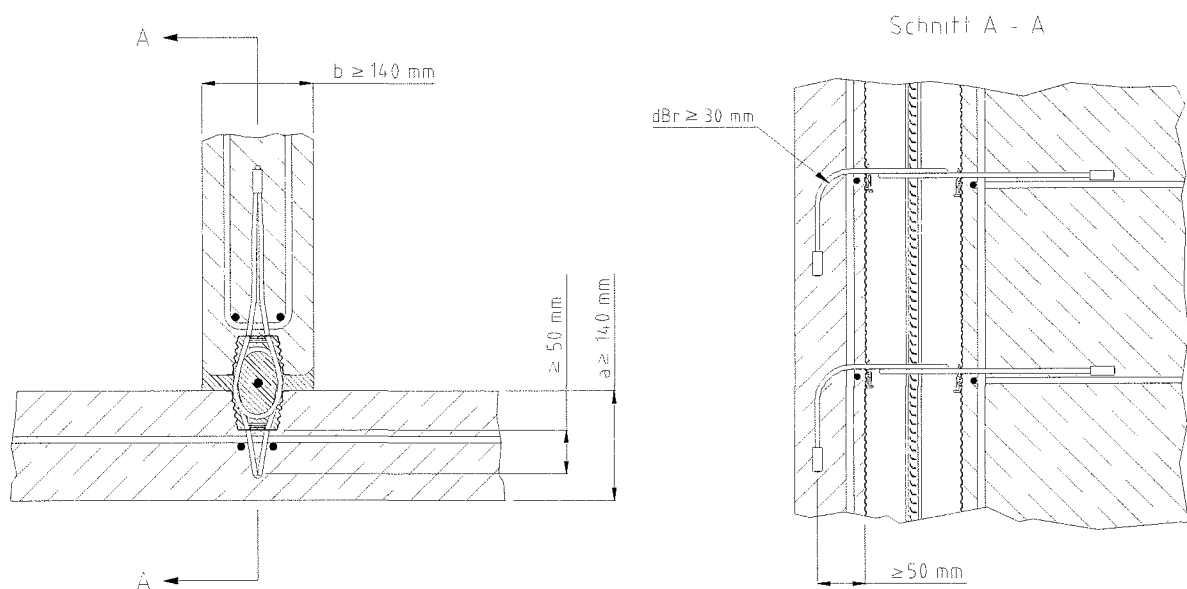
Wand – Wand – T-Verbindung - Detail bei abgewinkelter Seilschlaufe
